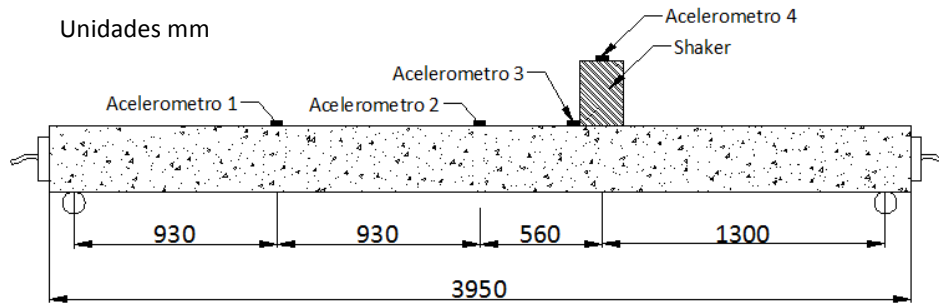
Esquema de la viga de concreto sección 25 x 30 x 395 mm
